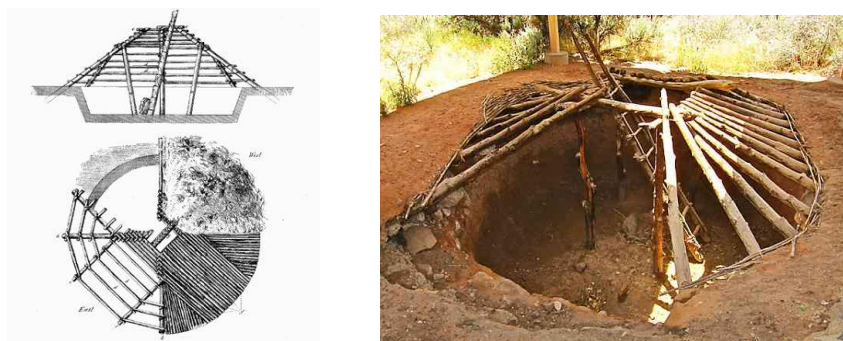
Habitações subterrâneas ou "pit house" [11] [12]
